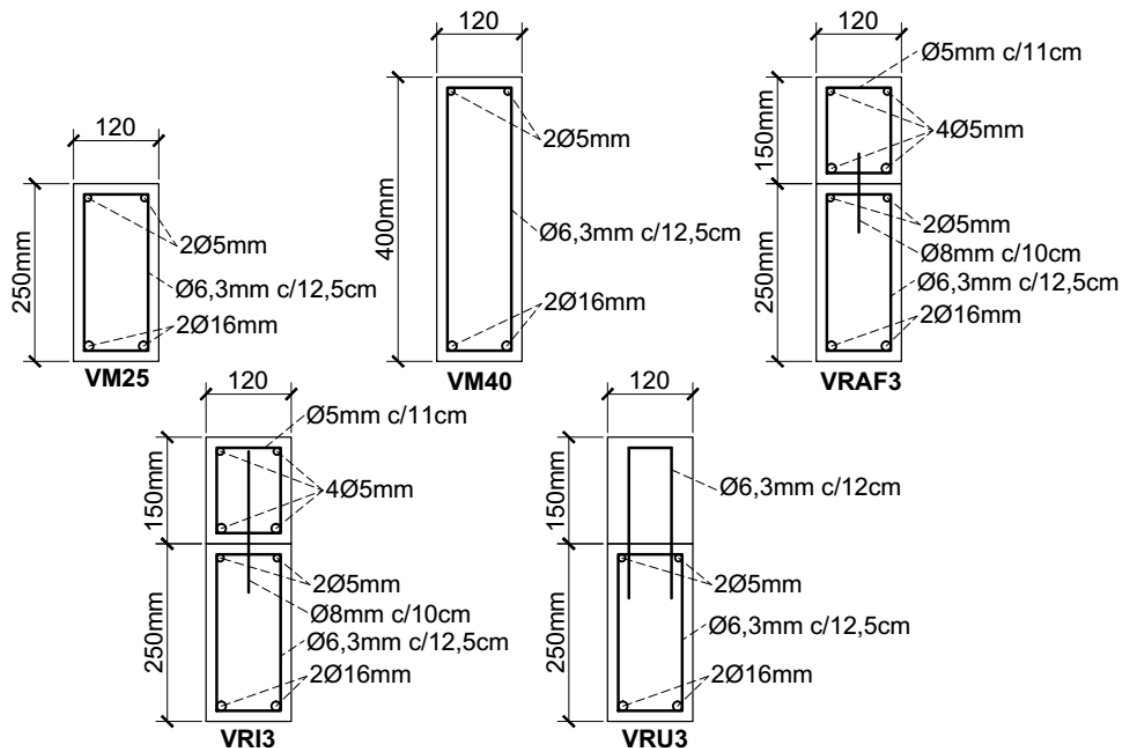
Detalhamento das vigas da primeira série (SILVA, 2011).
